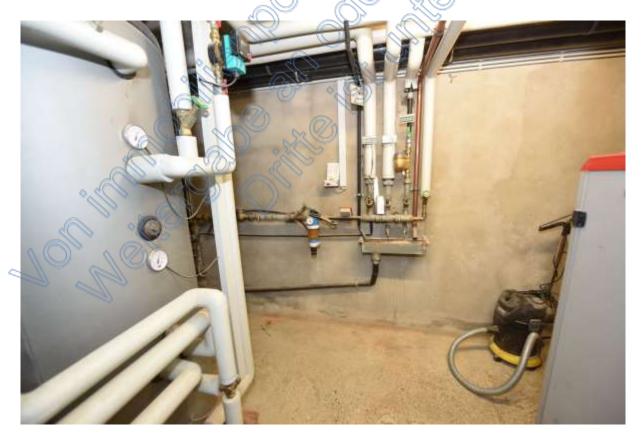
Kellergeschoss. Heizungsraum, Hausanschlüsse
